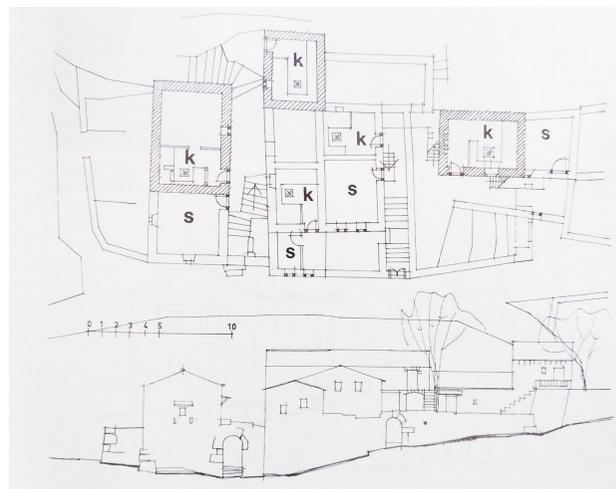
| Dorf Grmljani, Grundriss und Ansicht
